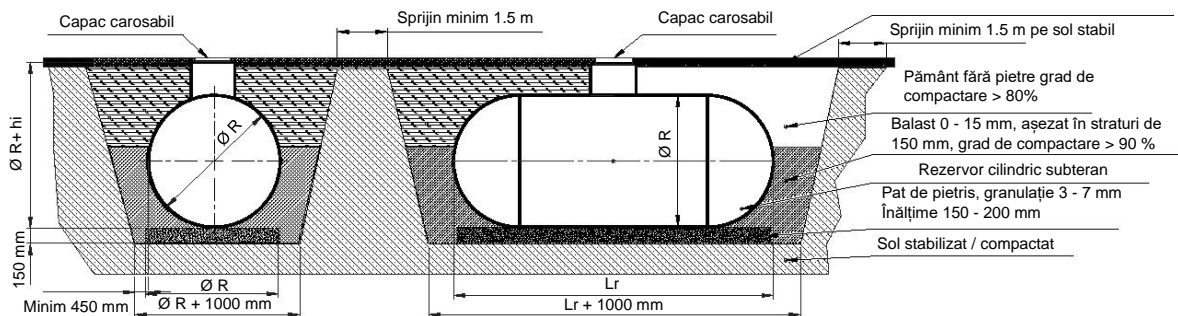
Instalare în zonă cu trafic auto
